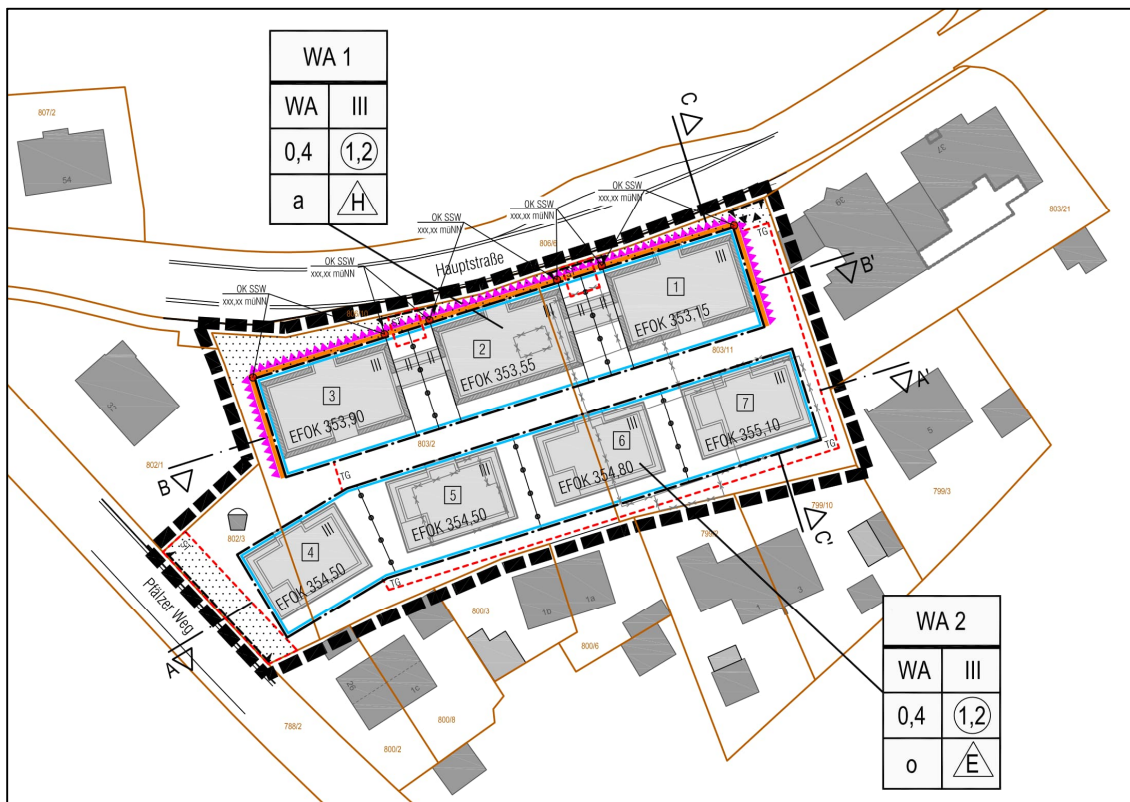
Auszug aus dem Planentwurf zum Bebauungs- und Grünordnungsplan "Kareth – Hauptstraße mit Teiländerung Bebauungsplan Berzlfelsen I" /23/ der Marktgemeinde Lappersdorf
